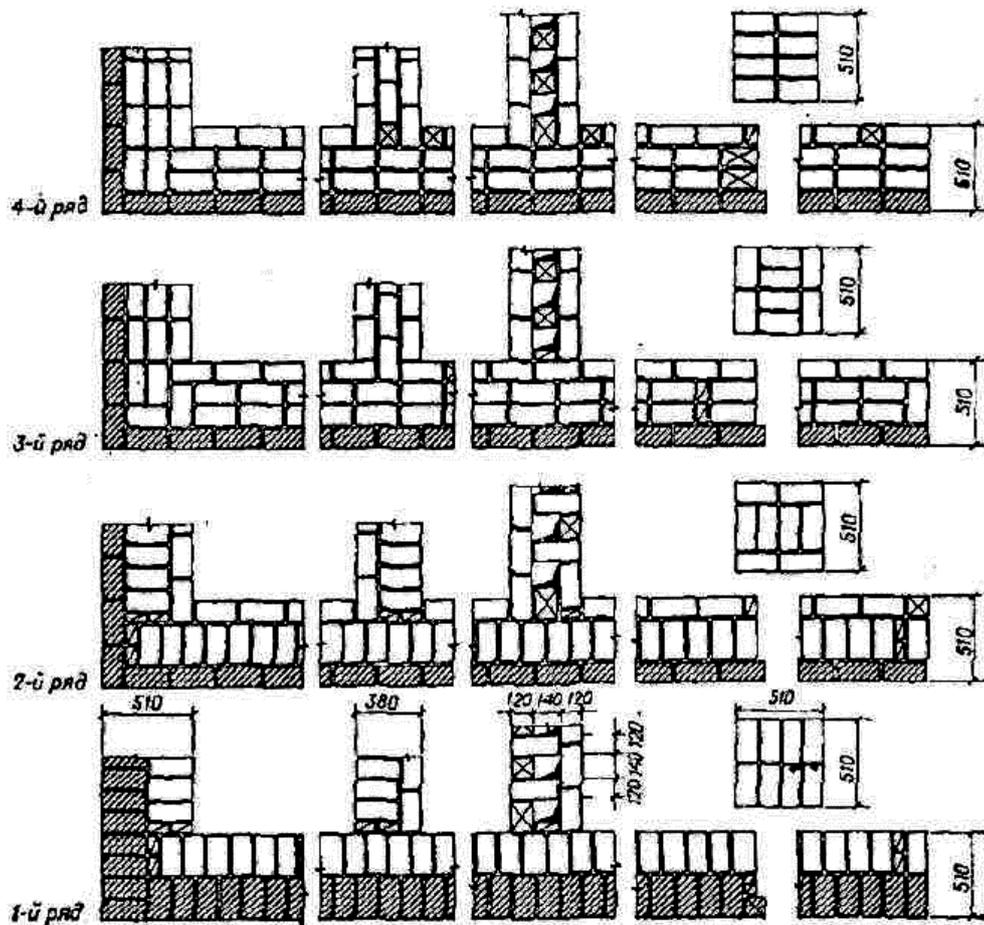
Планы порядовки наружной стены с лицевой декоративной кладкой (система перевязки многорядная) и кирпичного столба площадью сечения 510 × 510
